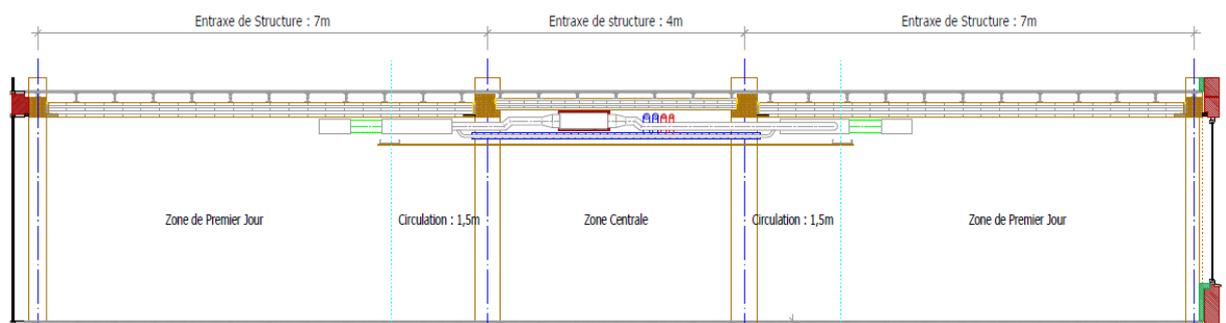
Vue en coupe d'un niveau du bâtiment projet
